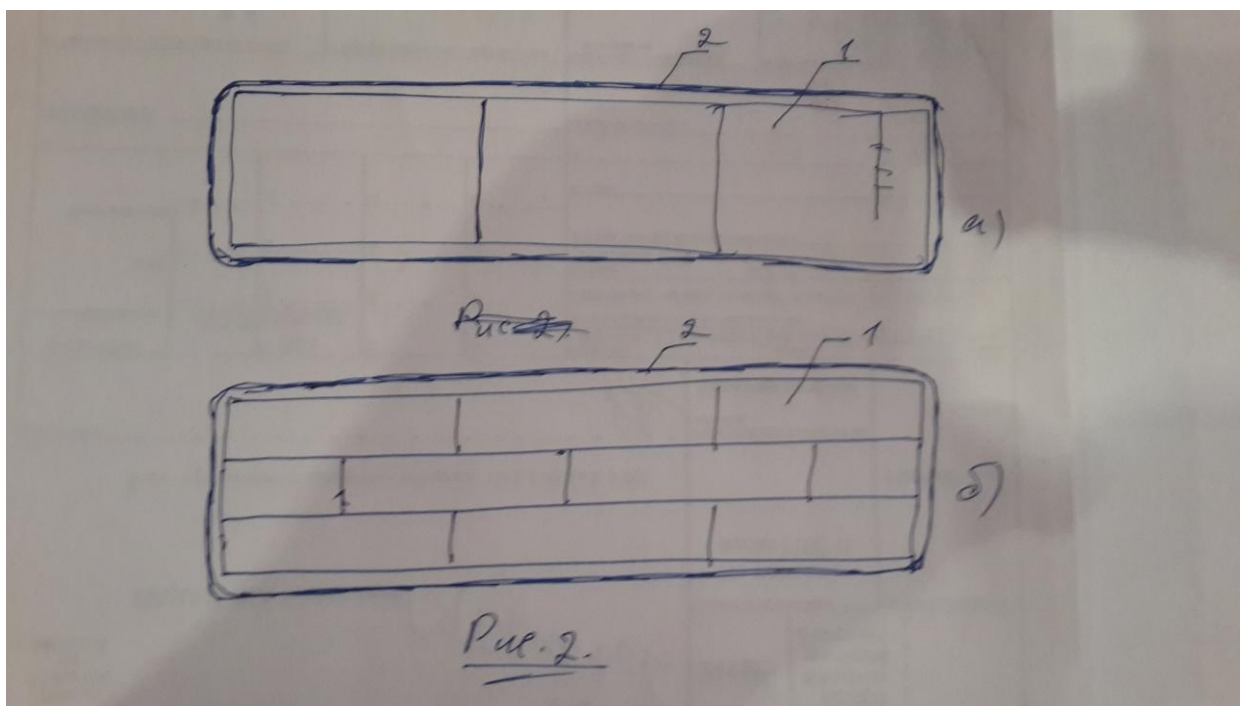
Схема газобетонных перемычек в замкнутой обойме: а) – без перевязки швов; б) – с перевязкой швов. 1 – газобетонные блоки, 2 – замкнутая преднапряженная обойма из полипропиленовой ленты
